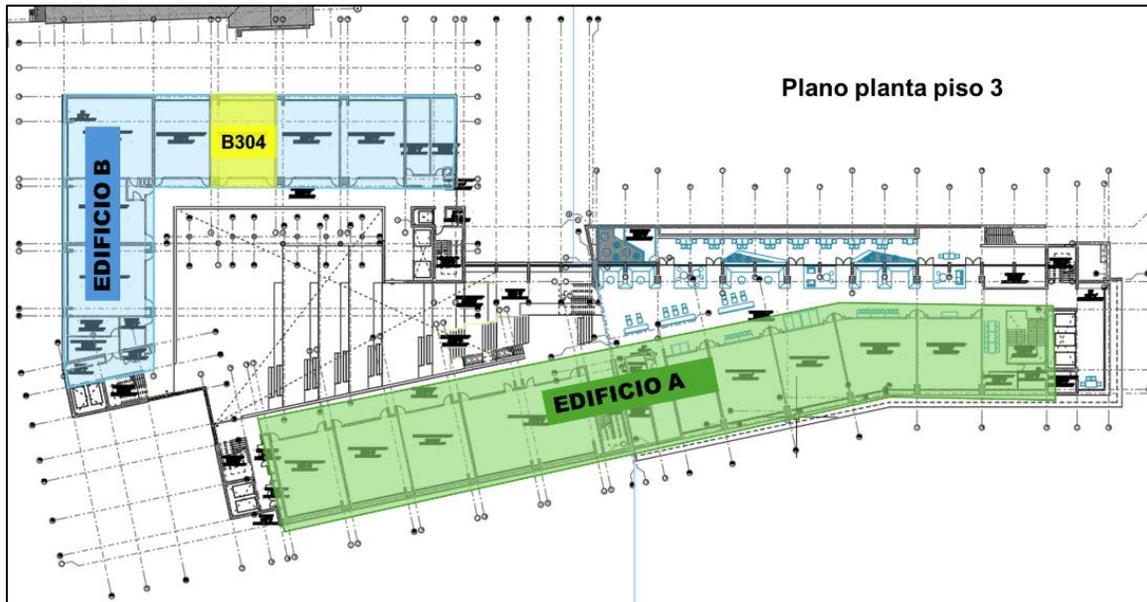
Plano general del piso 3 Sede Bellavista – AutoCAD
